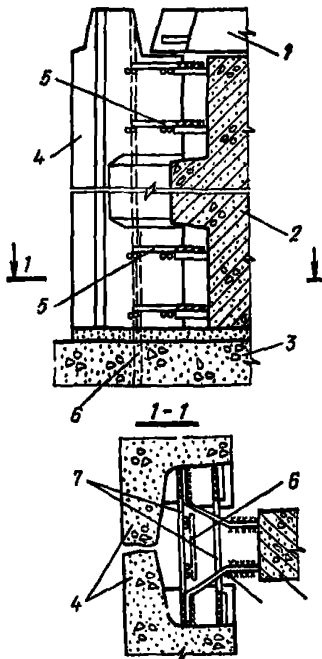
Узел сопряжения наружных цокольных панелей с внутренними для жесткой фундаментной части
